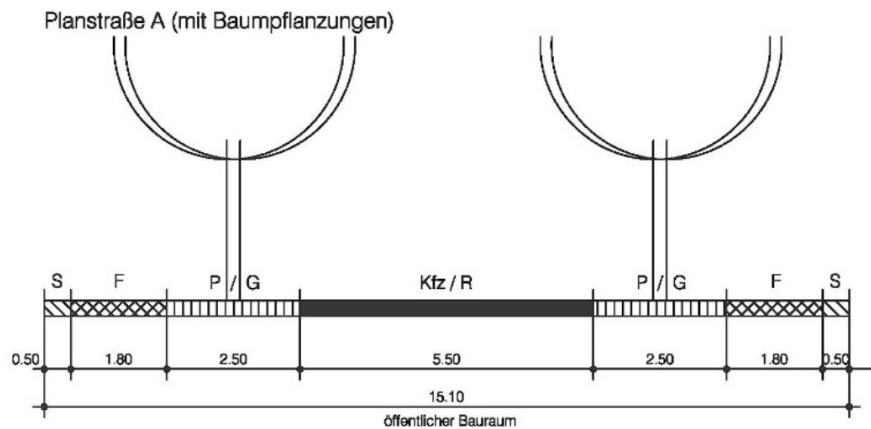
empfohlener Straßenquerschnitt der Planstraße „A“
